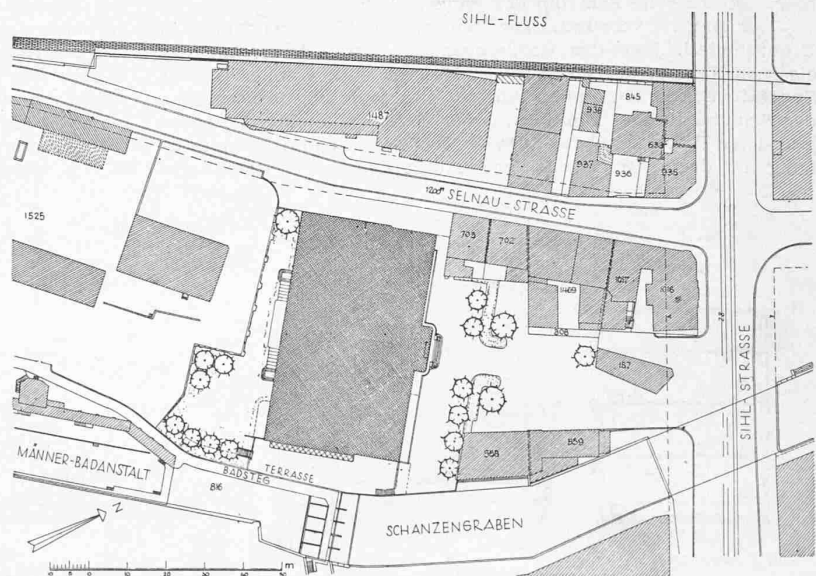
Lageplan 1:1800 des Zürcher Hallenbades (kreuzweise schraffiert)
